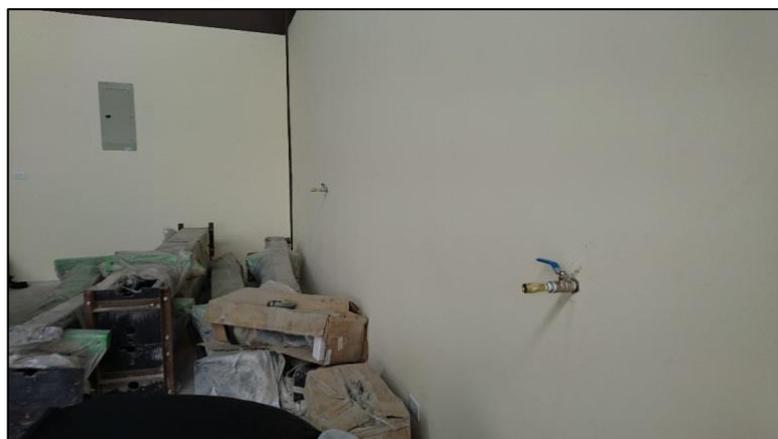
Elevadores sin armar y ubicación inadecuada.
